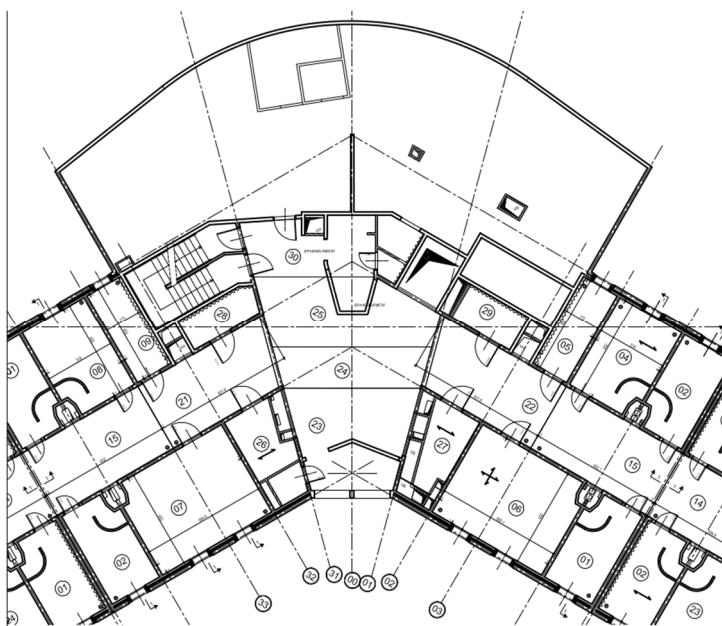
Plan Gros-Cœuvre R+2, bâtiment CD2, DOE
